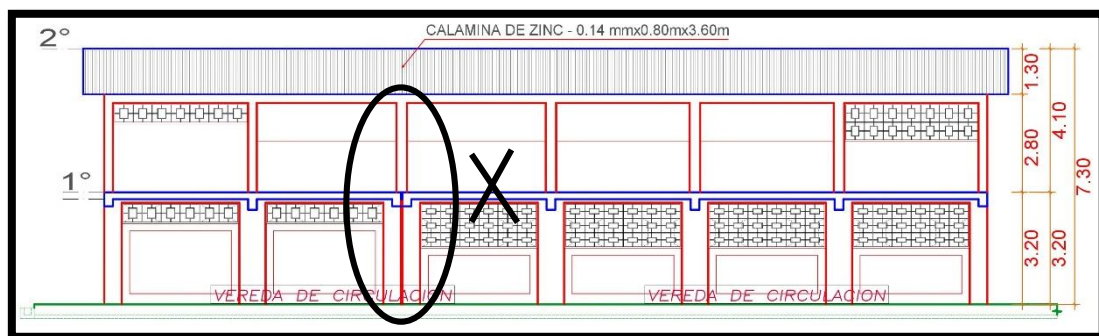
Plano de elevación posterior _Módulos IV y VIII; desaparece junta sísmica en el 2° piso
